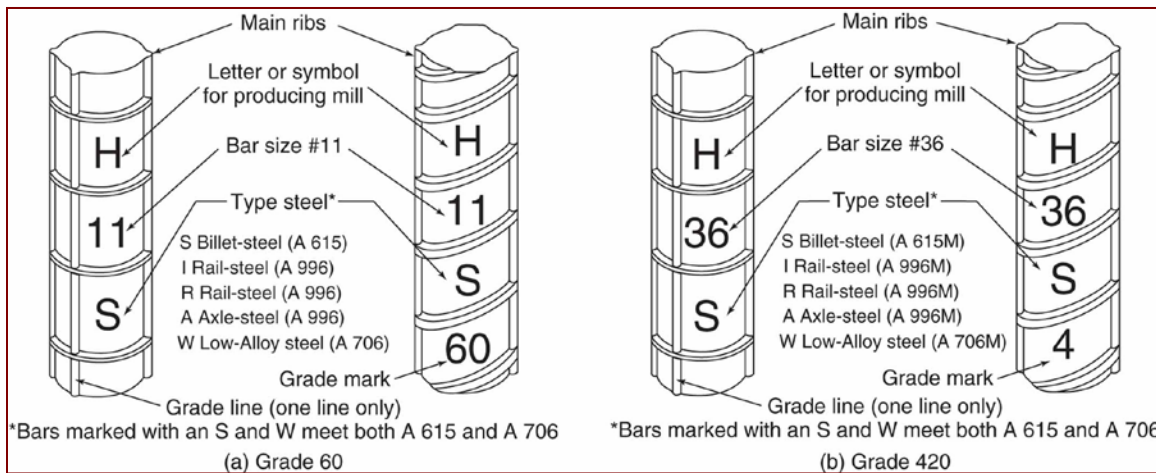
Señalización normal de barras de refuerzo. (Cortesía de Concrete Reinforcing Steel Institute, CRSI)
